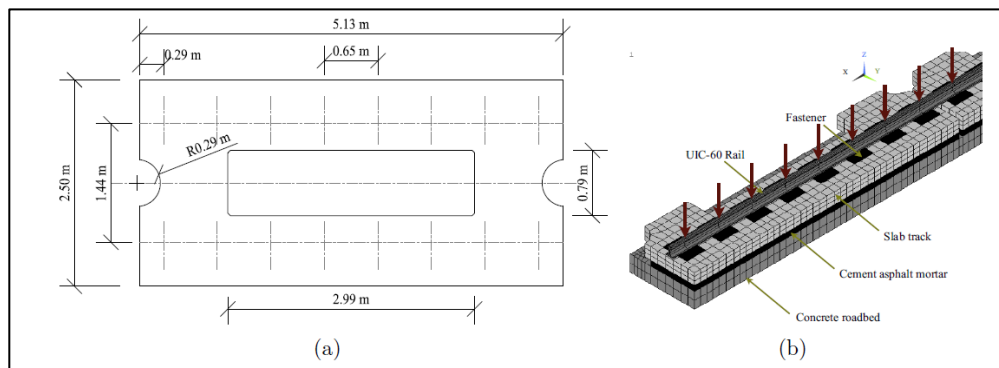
(a) Modelo de placa individual en planta y (b) componentes de la estructura de vía en placa
